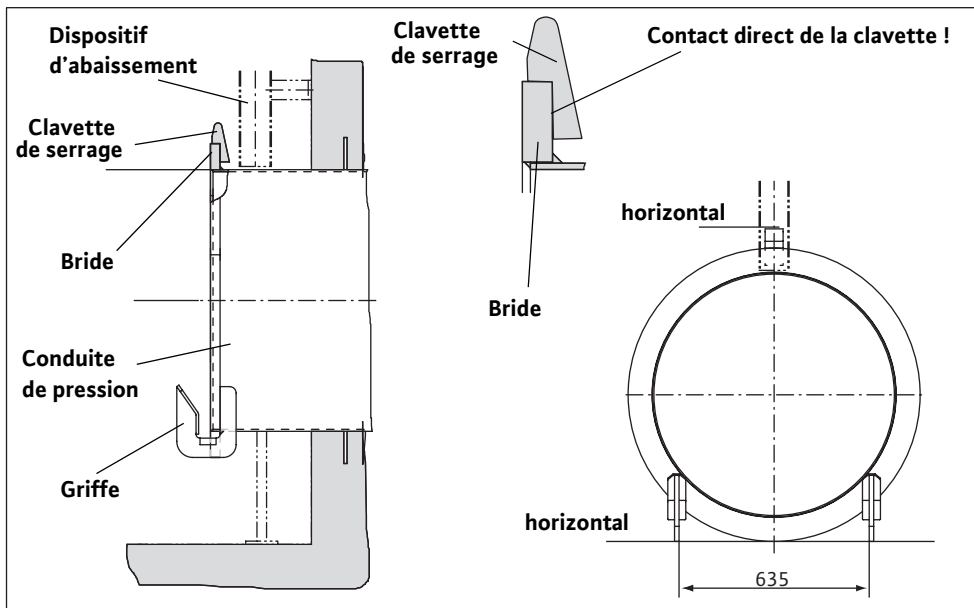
Montage sur la conduite de pression avec anneau en acier
